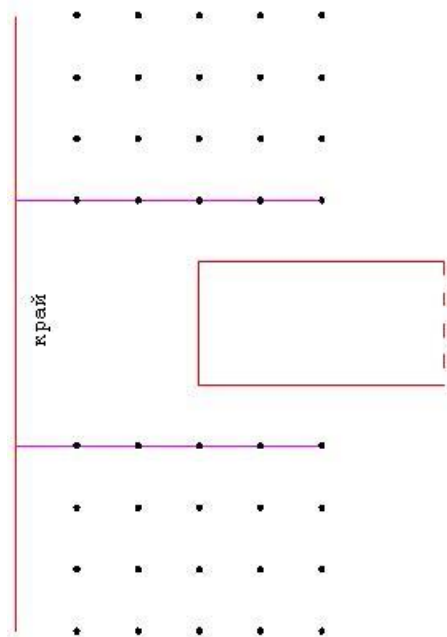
Размещение хомутов при продавливании краем стены с учетом края плиты
